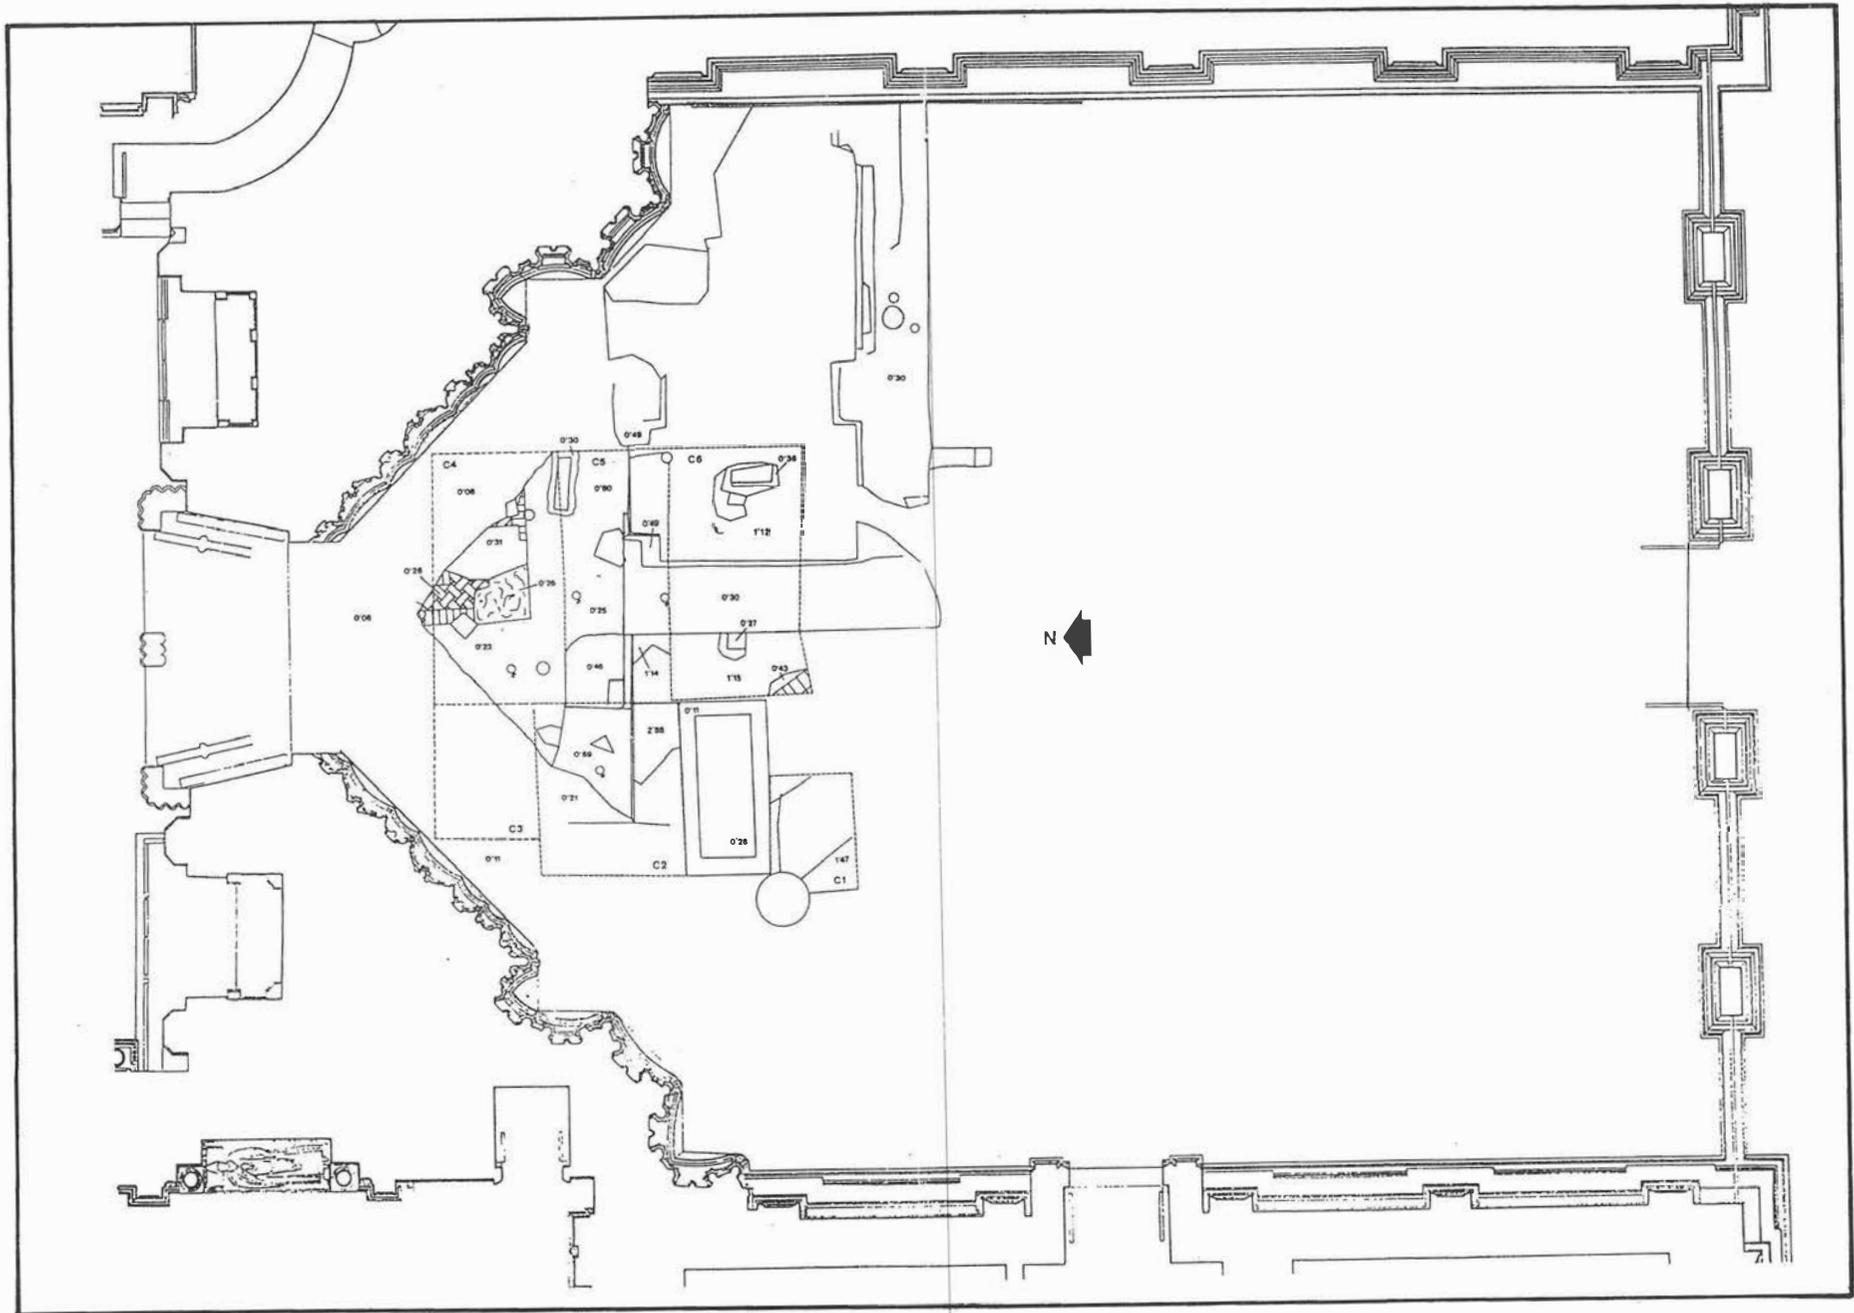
Planta general de la excavación. Planimetría base cedida por la Catedral de Sevilla. Autora: Isabel Pérez Peñaranda.
